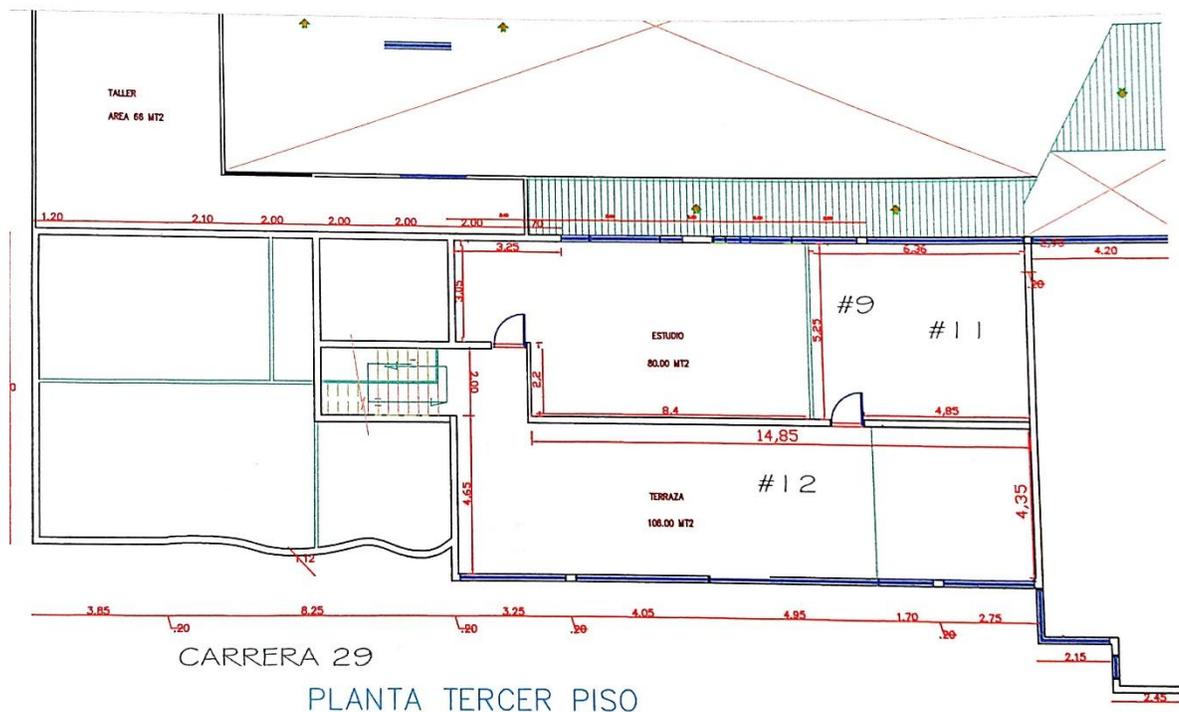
Plano arquitectónico tercer nivel sede I.T.L.S.
